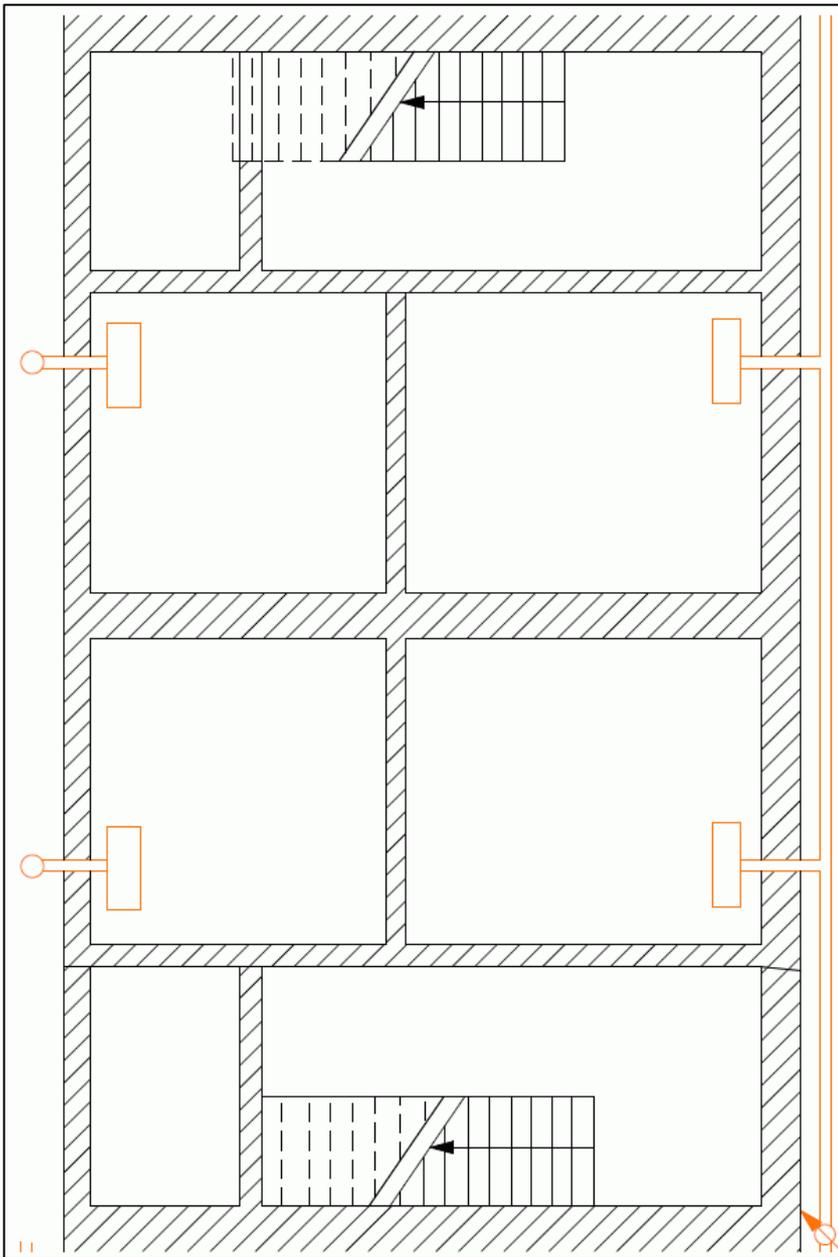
Prinzipielle Lösungen für die Anordnung mehrerer Radonbrunnen unter einem Gebäude, einschließlich Darstellung der Rohrführung
